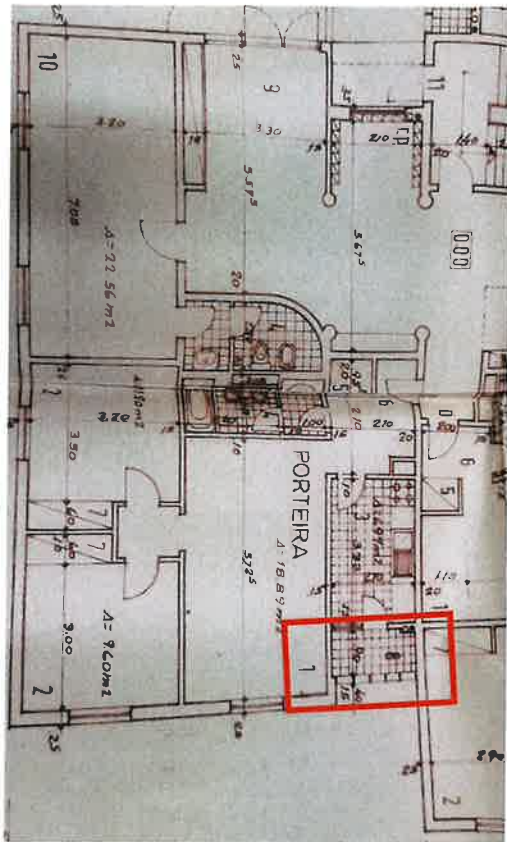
Excerto da planta do piso 0, nomeadamente a casa da porteira, com indicação da zona onde se verificaram as descargas para a via pública
